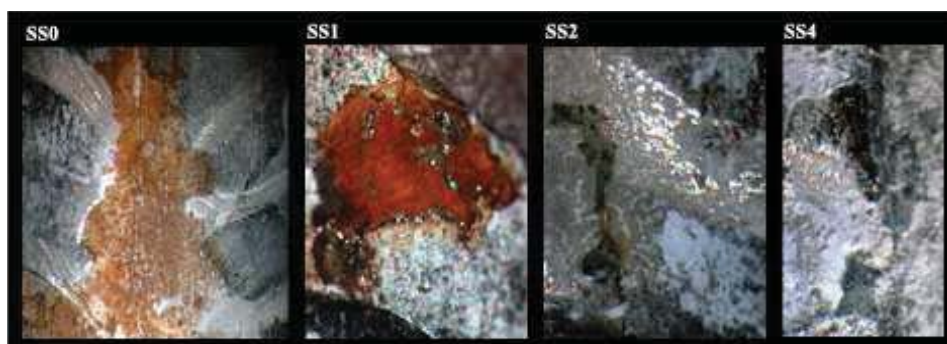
Amostras exibindo os efeitos da corrosão localizada no betão D fissurado.
